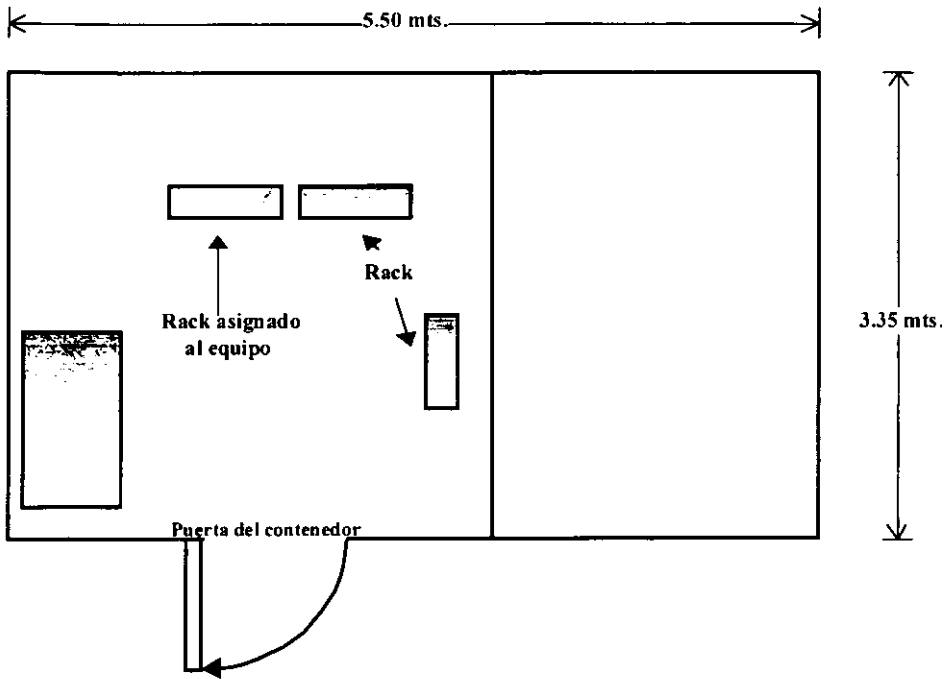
Ubicación del rack en donde se instalara el equipo
